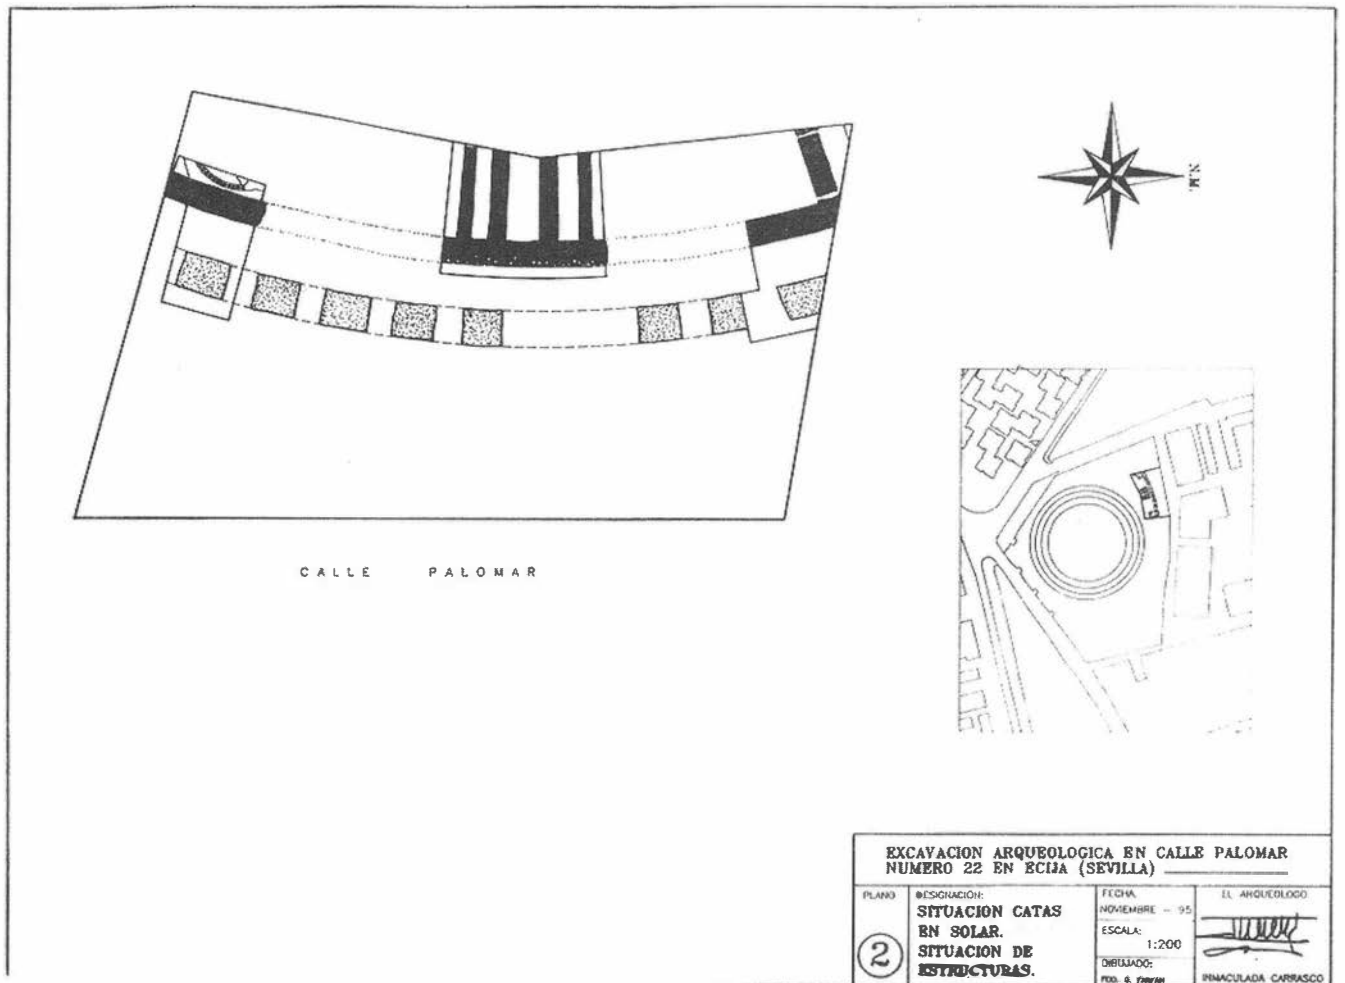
Plano general de la excavación con la situación de catas y estructuras.
